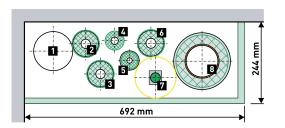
Planungsbeispiel einer Sammeldurchführung
